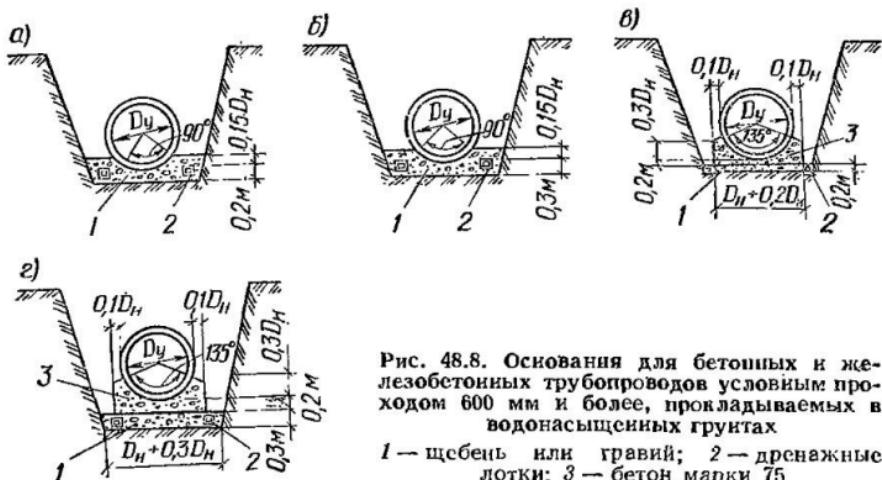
Основания для бетонных и железобетонных трубопроводов условным проходом 600 мм и более, прокладываемых в водонасыщенных грунтах
